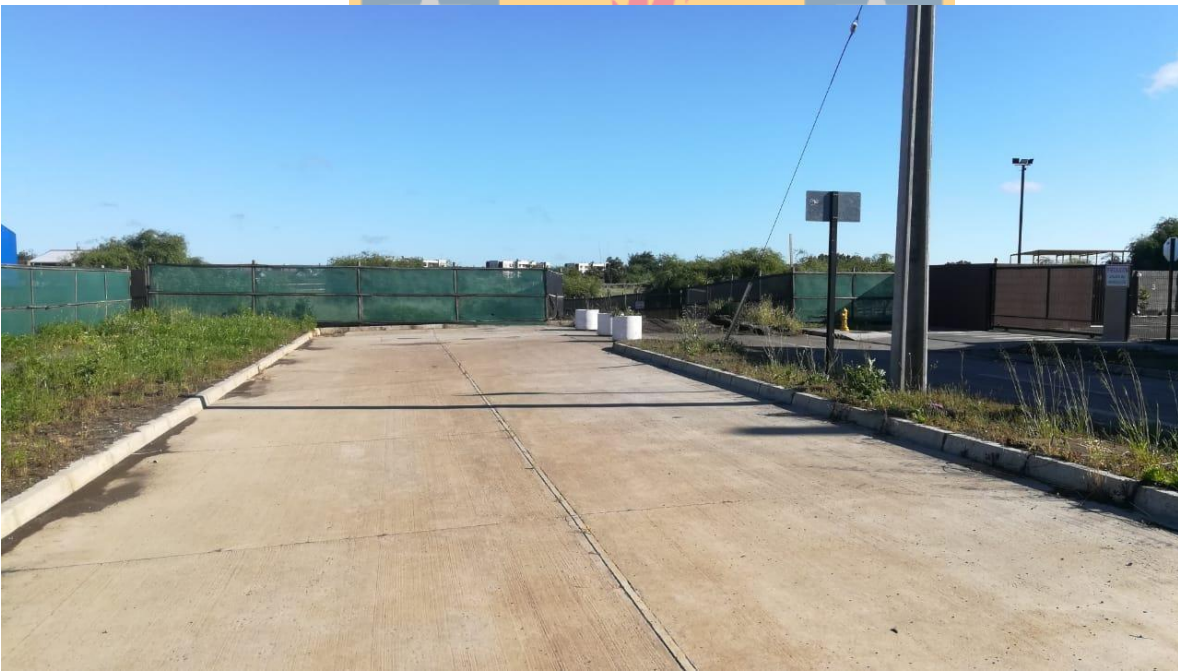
Corte Avenida Oriente, Sección ubicada frente a Condominio Los Quillayes Población Monte Cea, Fotografía capturada en dirección Norte. Elaboración propia.
